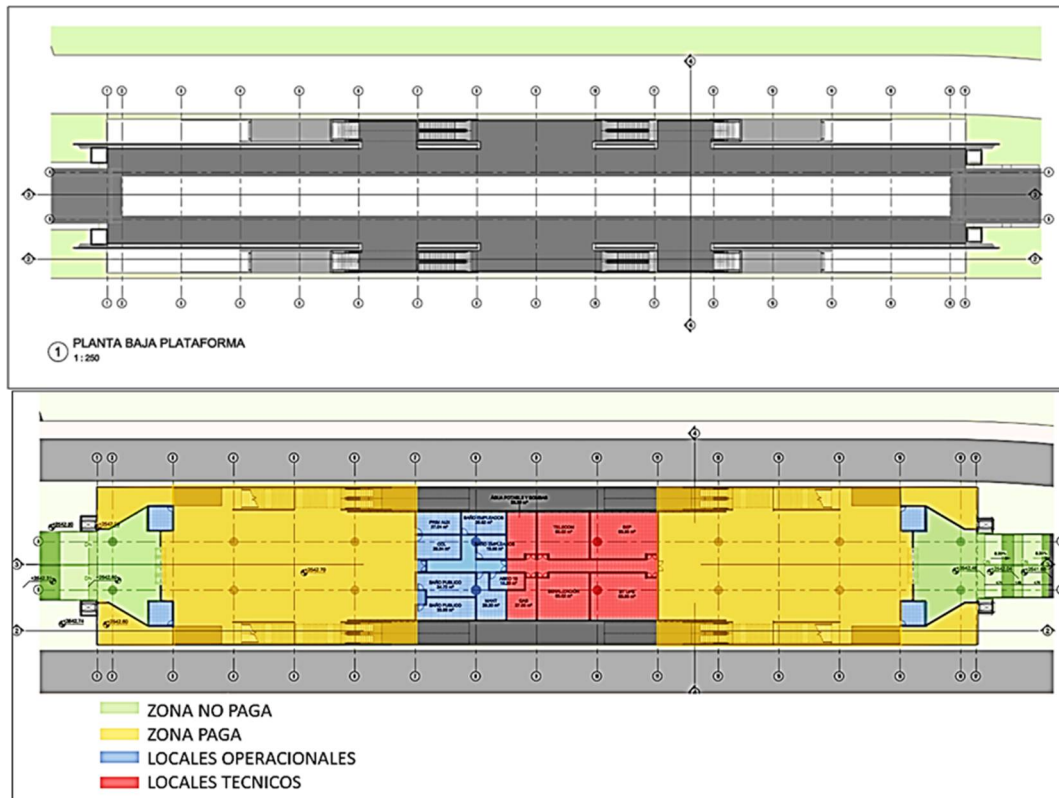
Planta baja plataforma y planta vestíbulo estación elevada E11
